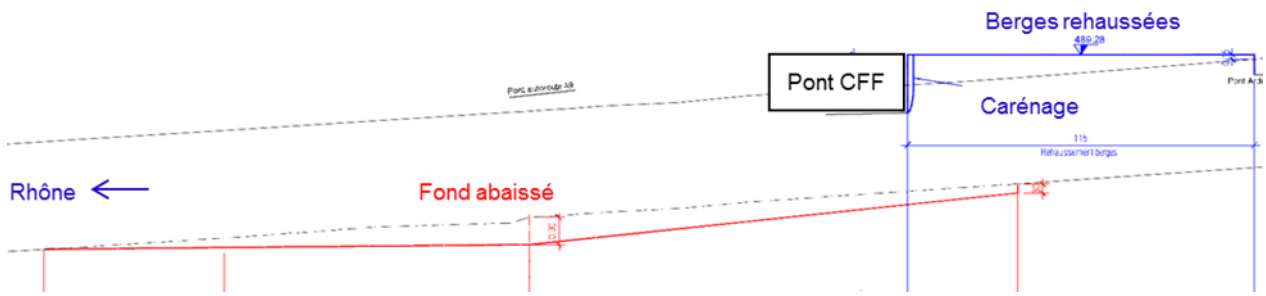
Profil en long de la Lizerne avec fond abaissé, nouveau pont CFF et berges rehaussées
